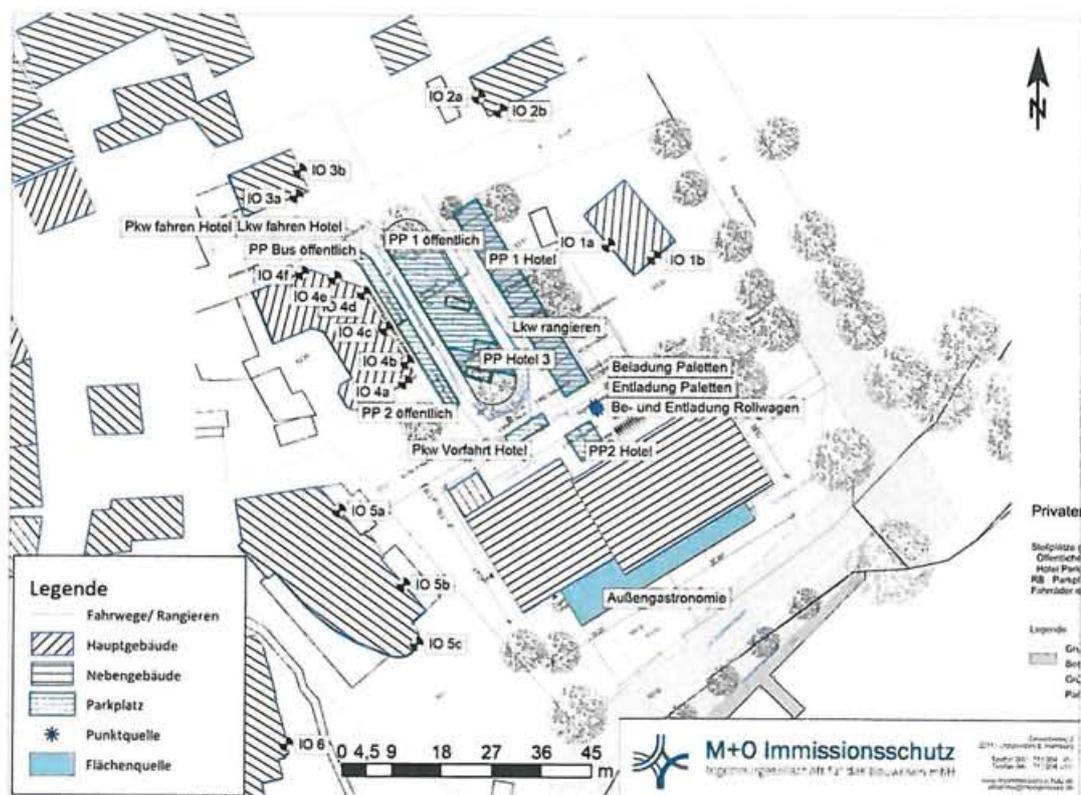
Lageplan der Lärmquellen des Hotels und der Immissionsorte¹⁸
